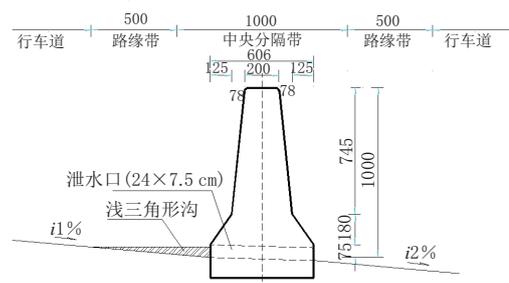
中央分隔带混凝土护栏示意图(单位:mm)
